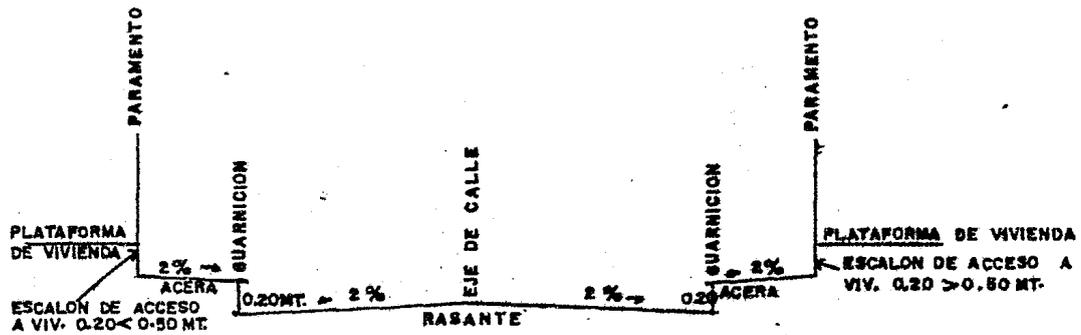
SECCION TRANSVERSAL DE AVENIDA, CALLE O ESTACIONAMIENTO
